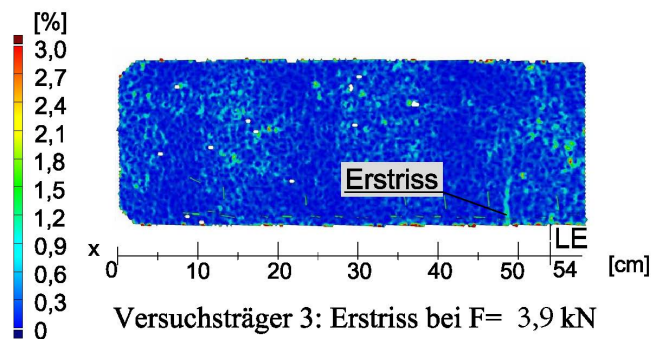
Versuchsträger 3- Lage Erstriss
